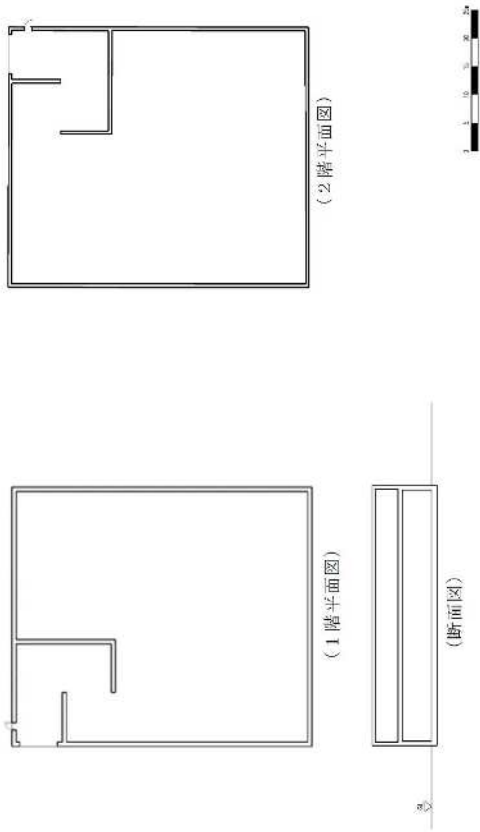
外部遮蔽壁保管庫平面図・断面図
